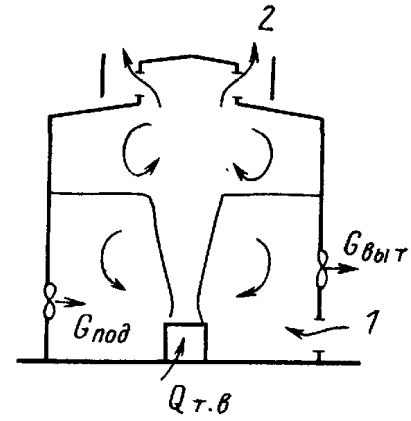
Схема аэрации здания, оборудованного местной механической вентиляцией
